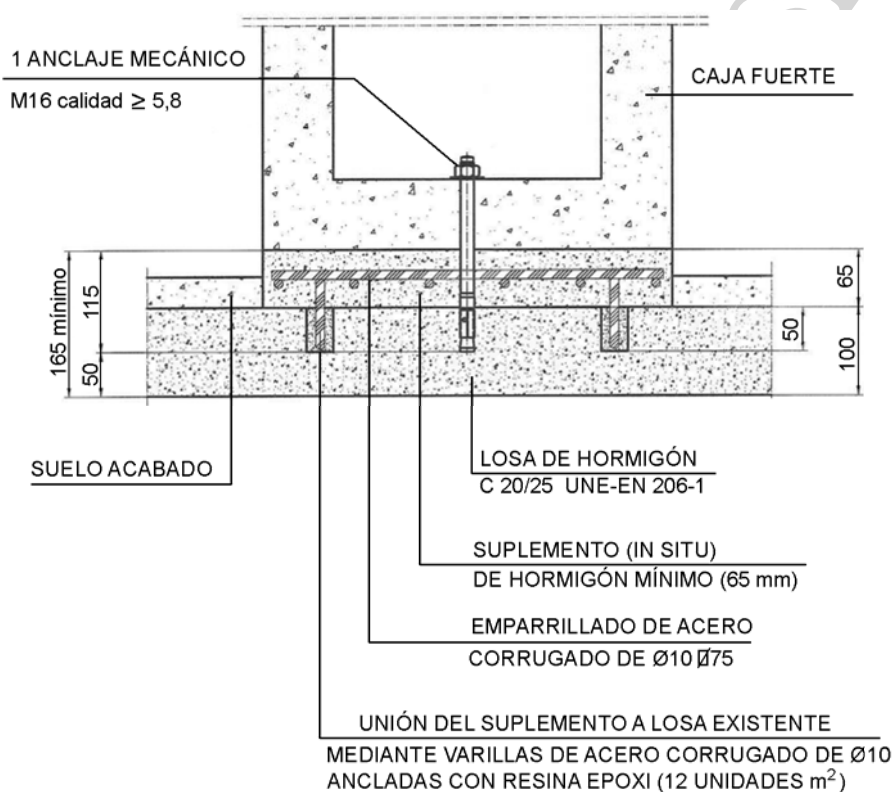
Anclaje mecánico en losa de hormigón suplementada
